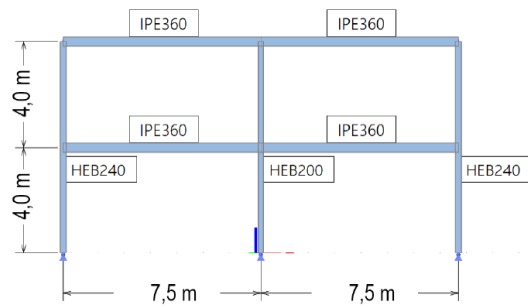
Geometría y sección transversal de miembros para marco principal. Fuente: [32]
